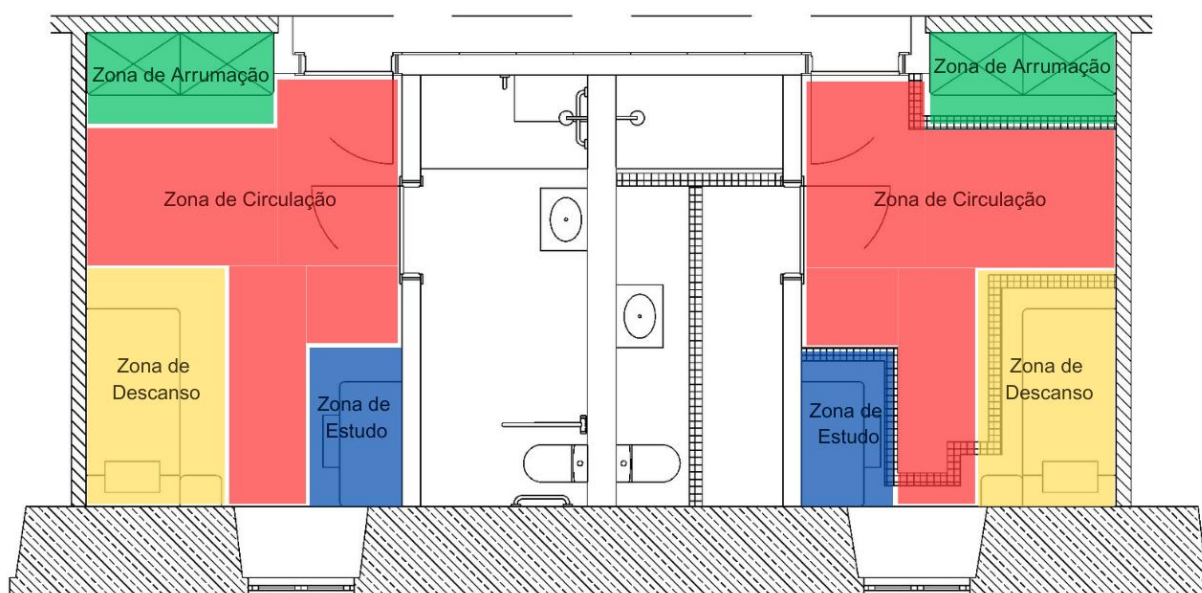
Planta de Zonas Funcionais; Fonte – Daniel Silva
